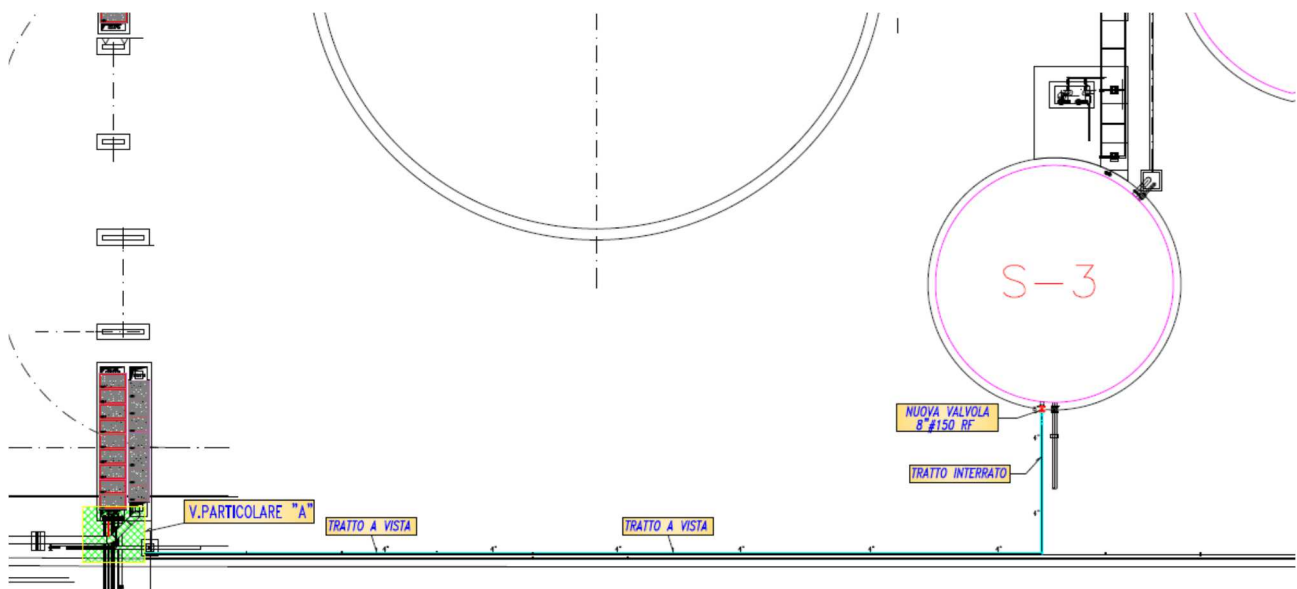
Stralcio planimetria sviluppo linea piping di collegamento (V-04 – S-3)
